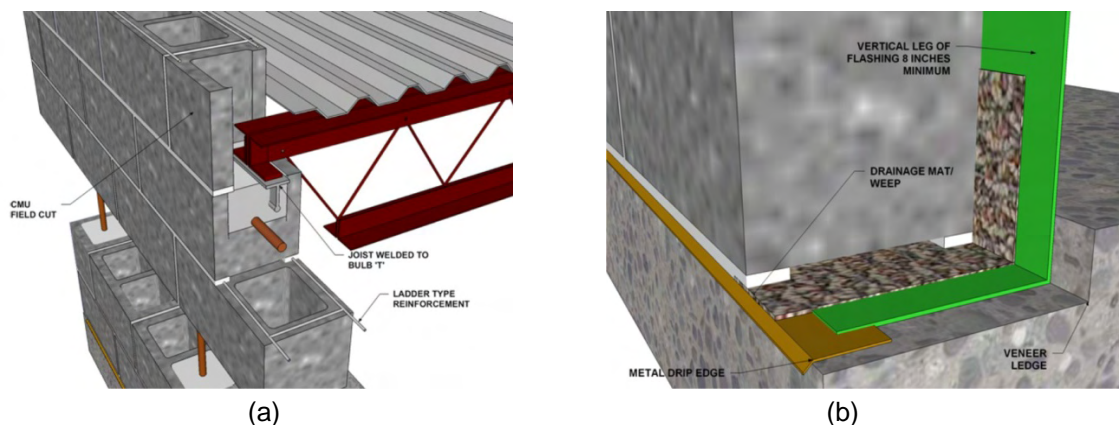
Sistema *Single Wythe/ Reinforced Concrete Block*.
